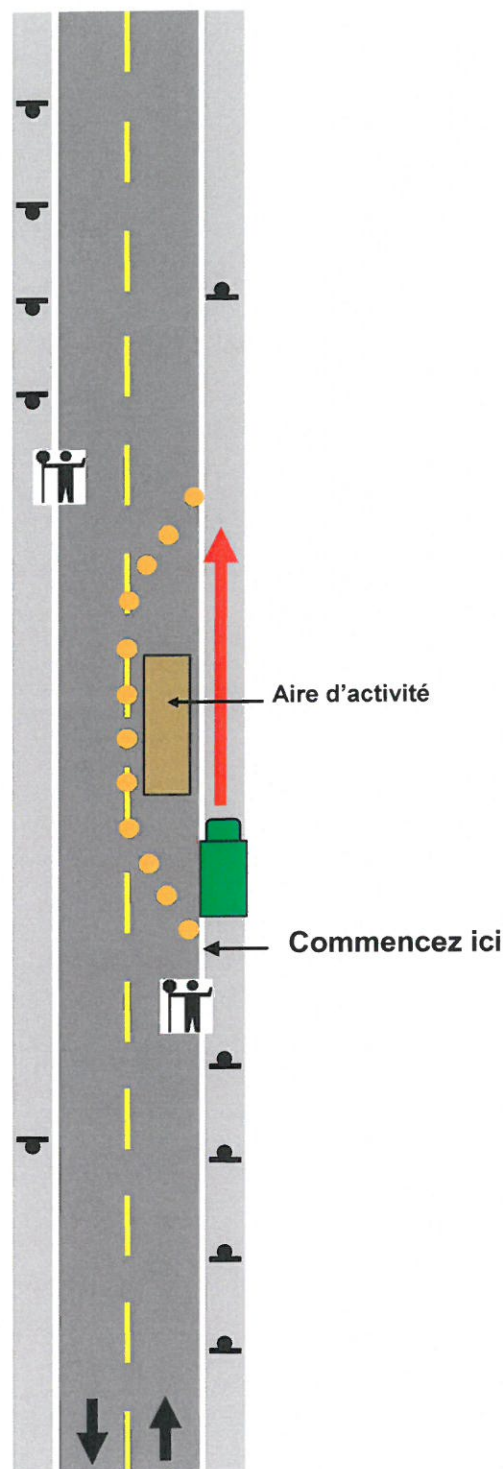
Installation pour la fermeture d'une voie (routes à deux voies)
